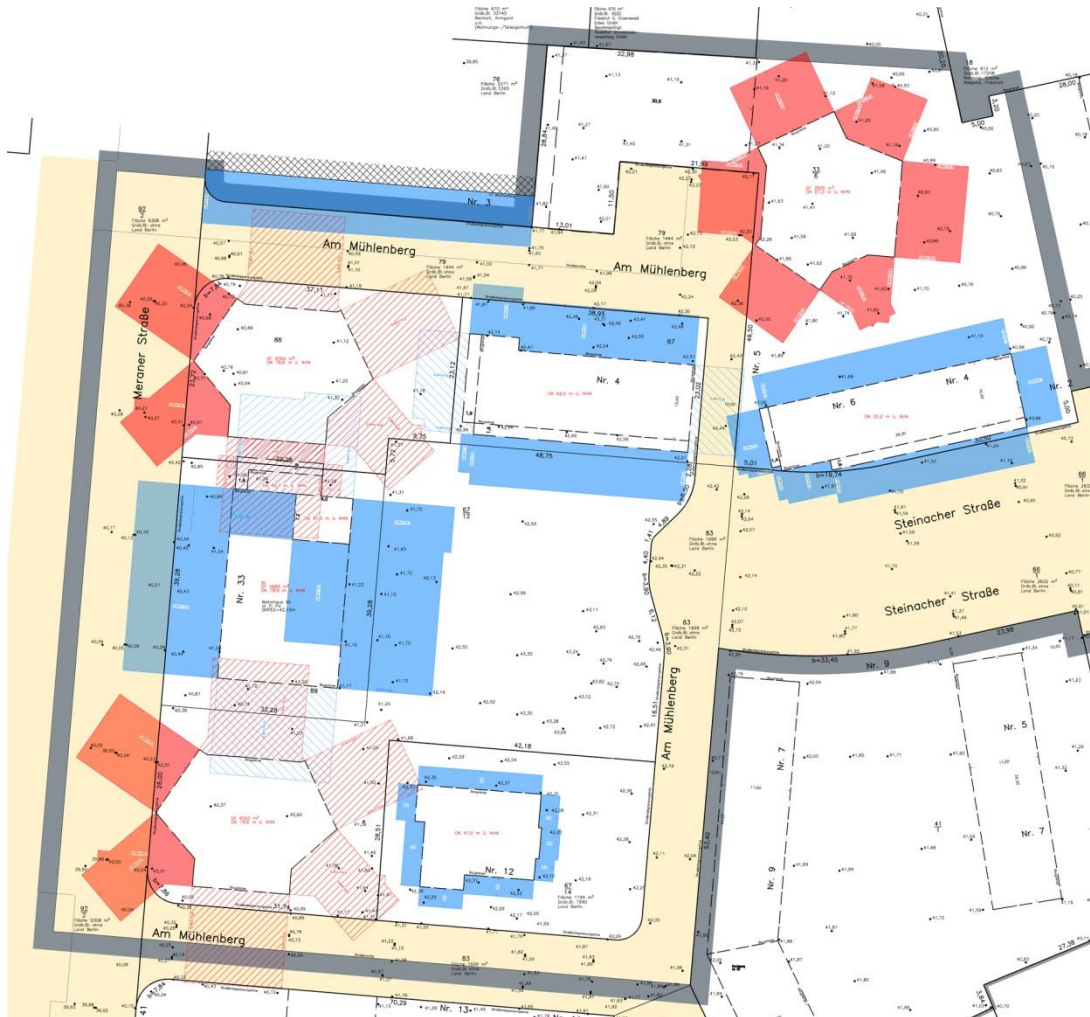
Lageplan vom 26.11.2020 mit Darstellung der Abstandsflächen, Vermessungsbüro ObVI Phuoc van Ho
